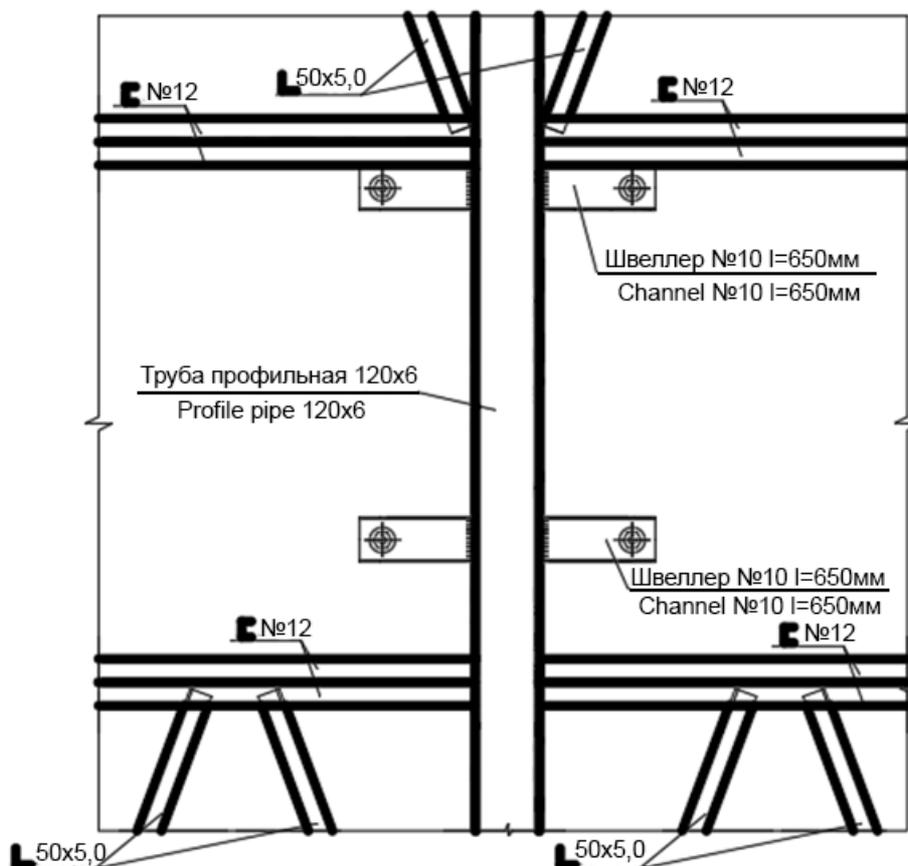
Схема расположения обрешётки для укладки утеплителя
